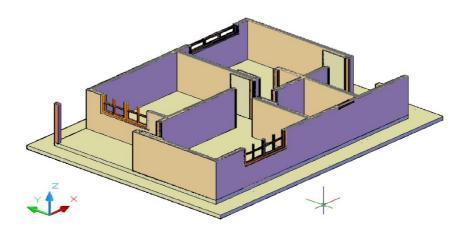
Ilustração do procedimento de obtenção de uma planta baixa.
